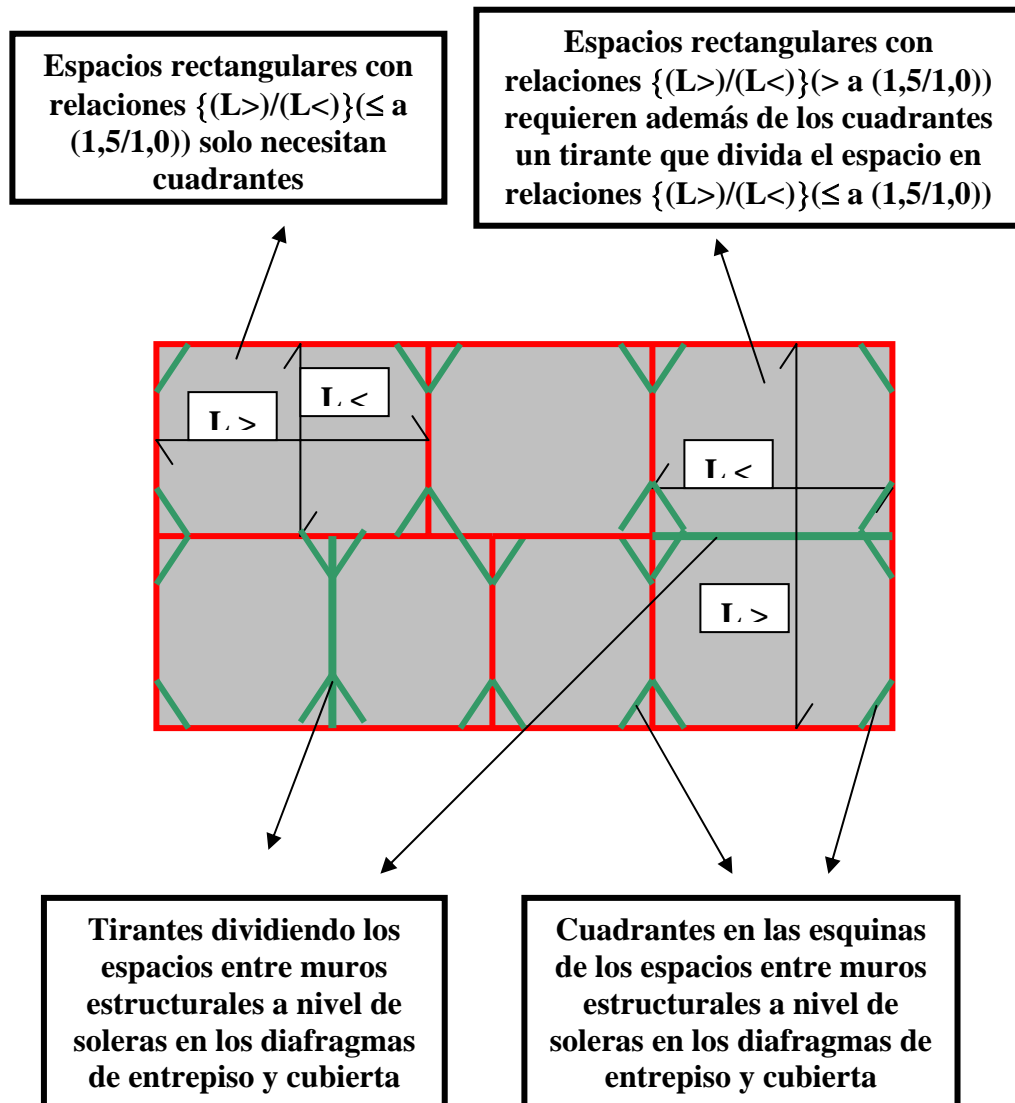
Detalle de la conexión del diafragma de cubierta con los muros estructurales
